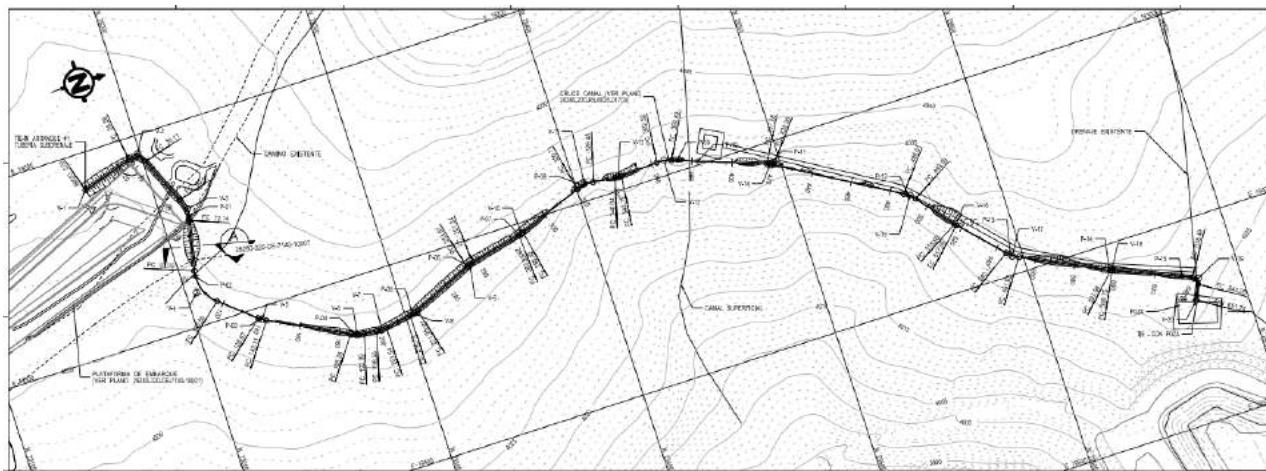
Vista en Planta – Línea de Tubería hacia Poza Sur
